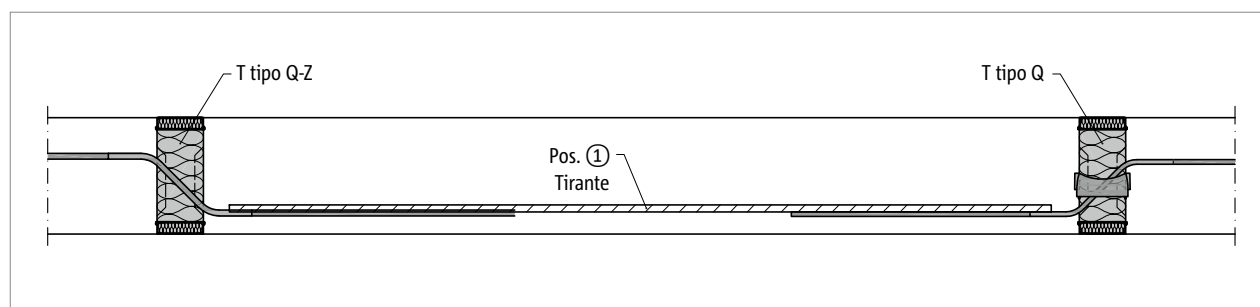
Schöck Isokorb® T tipo Q-Z-V5 - Q-Z-V10, Q-V5 - Q-V10: sezione A-A; soletta in calcestruzzo armato monodirezionale
